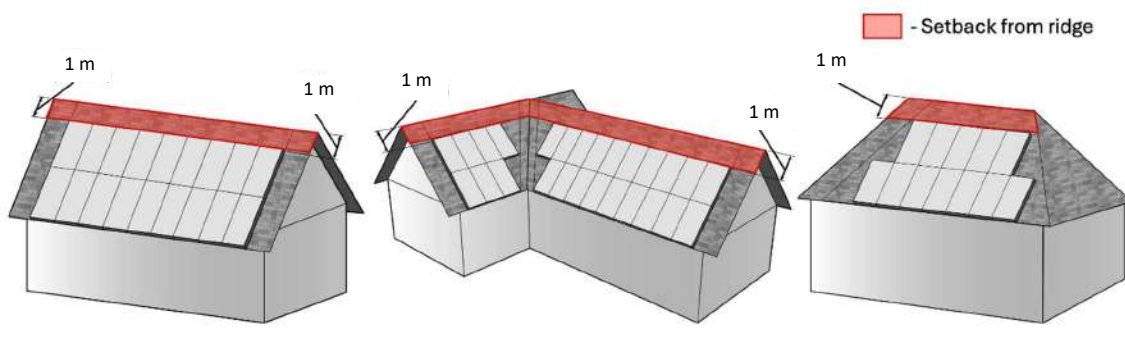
Lajuan di atas bumbung pinggul penuh
